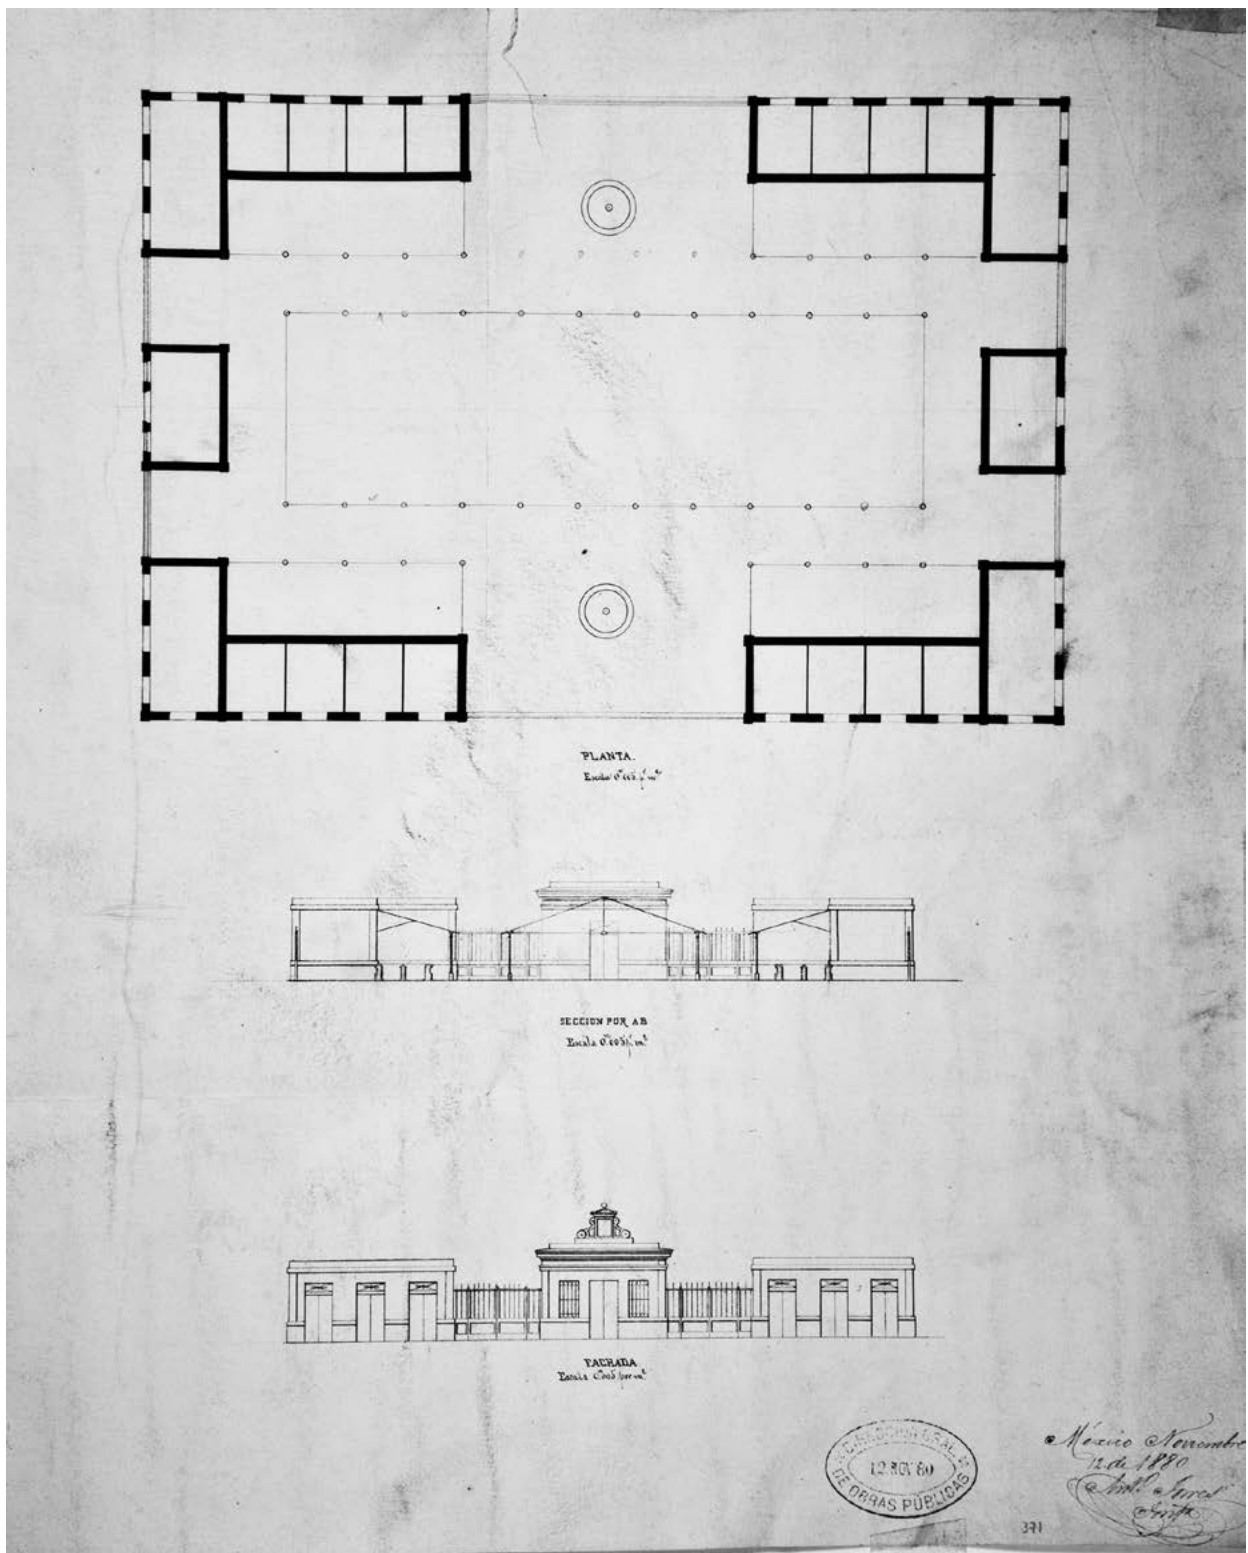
Plano del "Mercado en la Plaza de San Lucas". AHDF, Planoteca, módulo 3, planero 1, fajilla 43, detalle. Fotografía de Roberta Vassallo.
